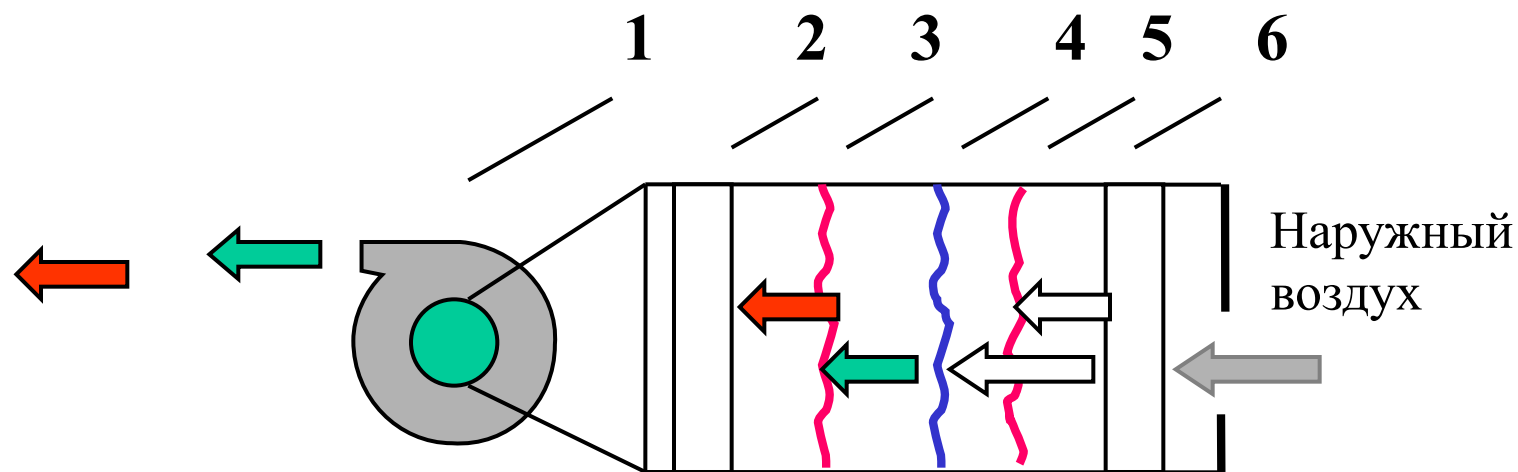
Местная приточная вентиляция - воздушное душирование.
